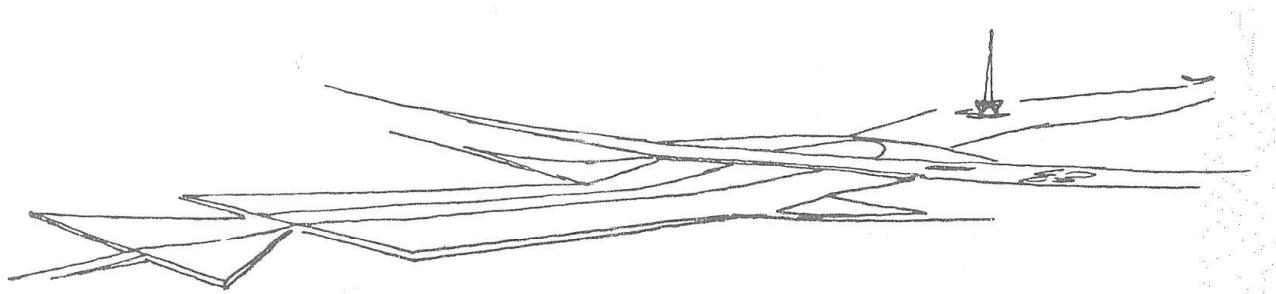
Perspectiva e planta da Praça dos Três Poderes (croquis do Plano Piloto de Brasília - 1957). Fonte: Costa (1991).
